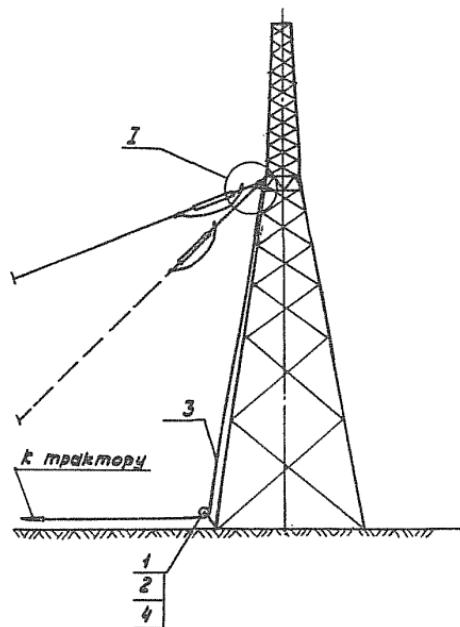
Подъем натяжной гирлянды с проводом на анкерно-угловую опору.
